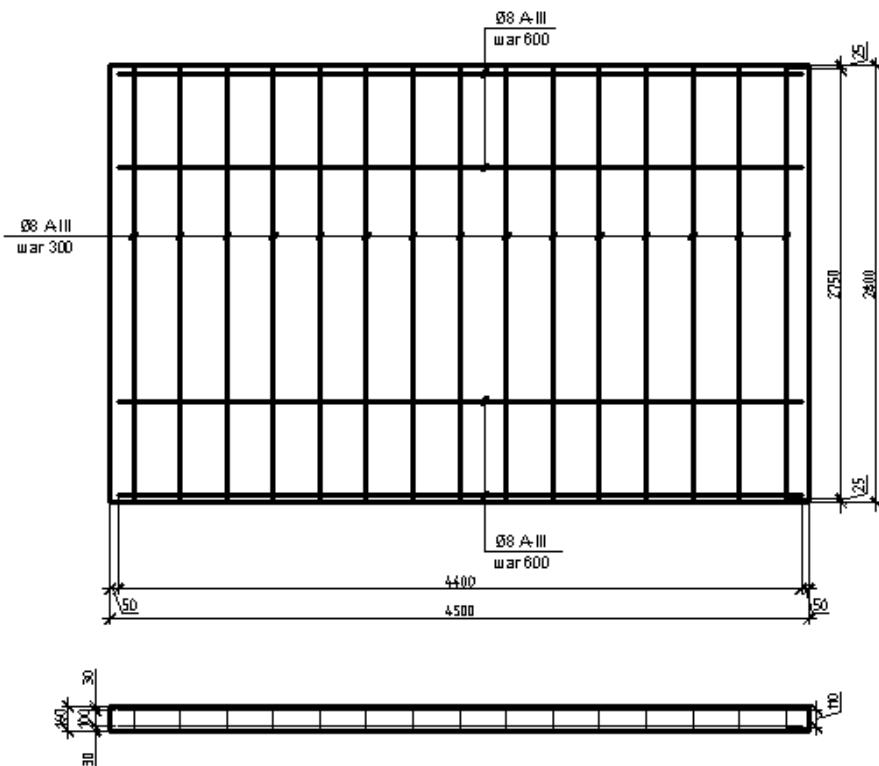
Армирование стеновой панели рабочей и конструктивной арматурой
